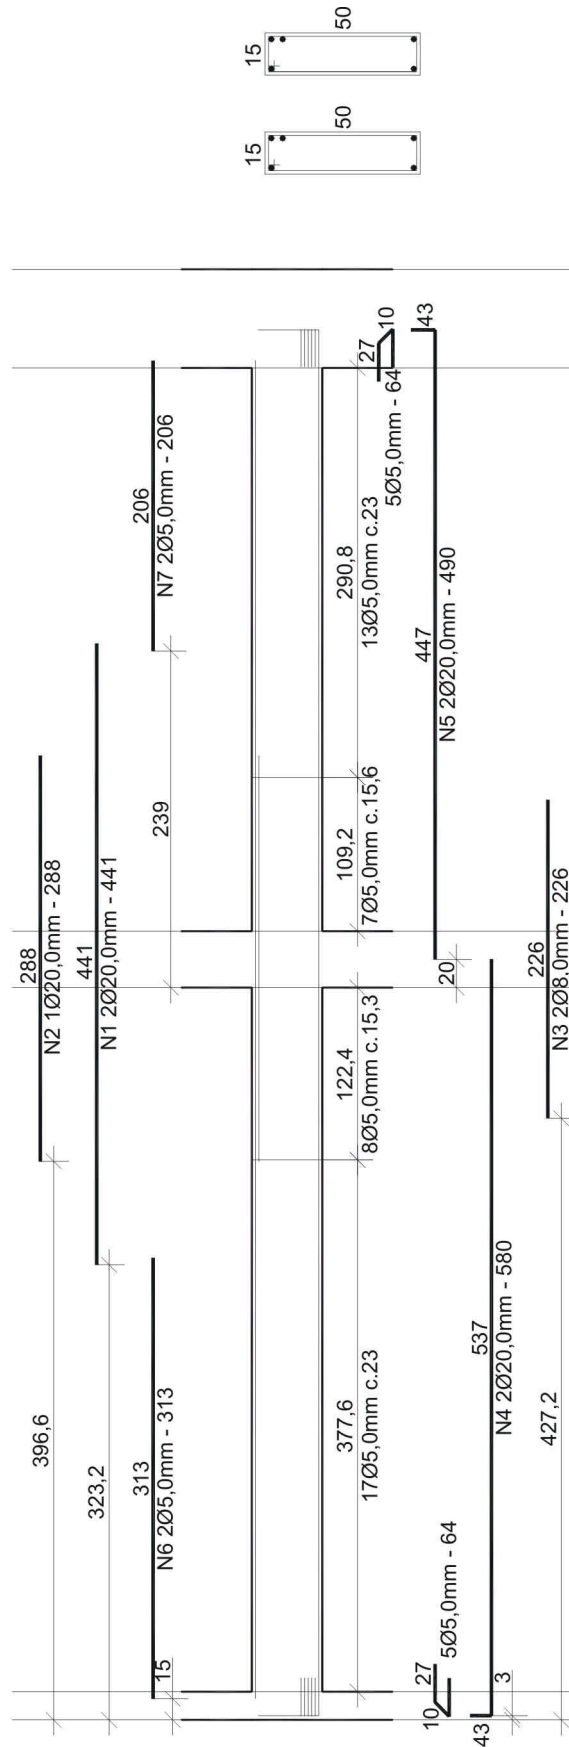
Detalhamento Viga 03.8, realizado pelo VigaCalc.
